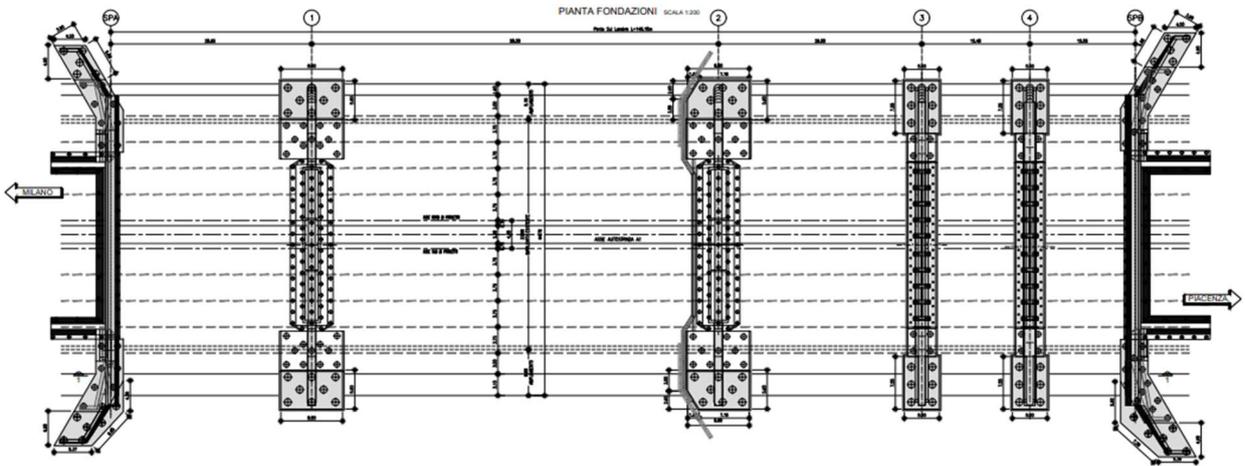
Pianta fondazioni Viadotto Lambro – configurazione modificata
